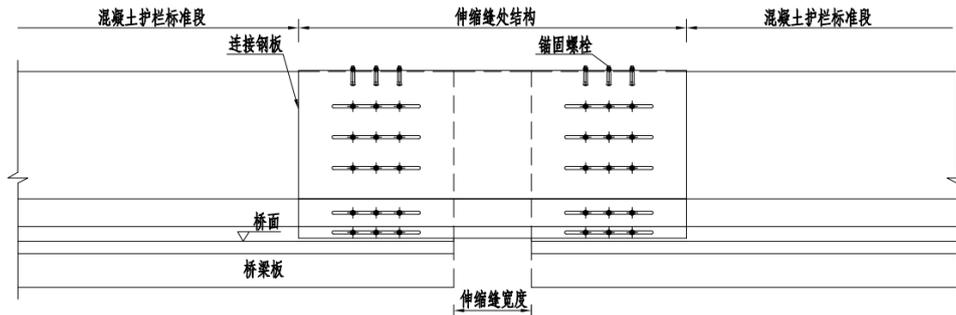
混凝土护栏伸缩缝处结构示意图
